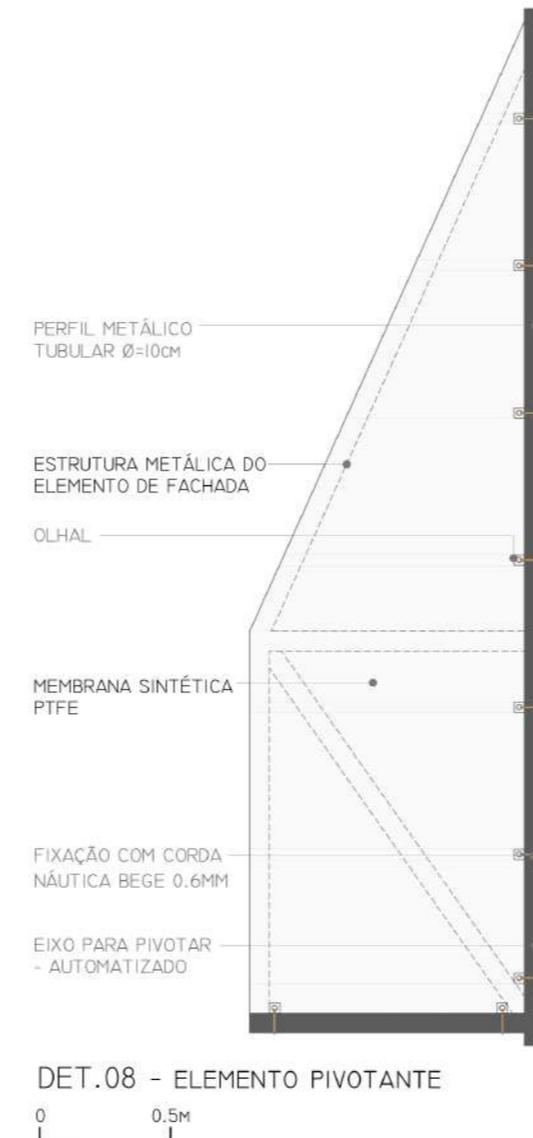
Detalhe 08 Elemento pivotante de fachada.
